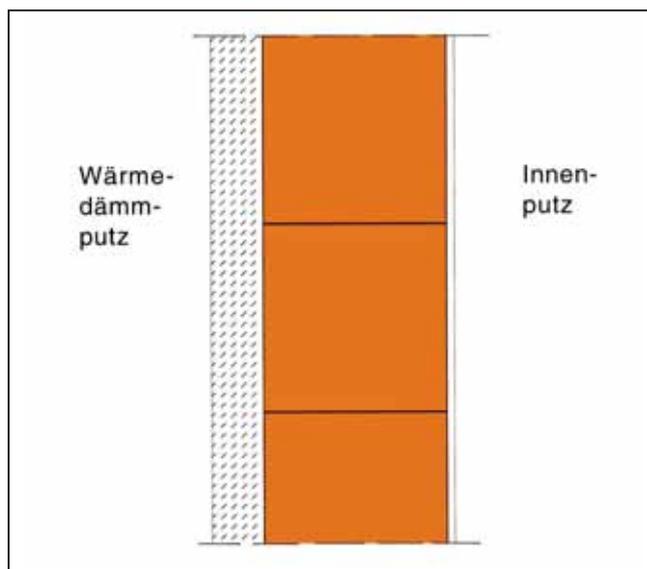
Schnitt durch einschaliges PlanZiegelmauerwerk und Dämmputz auf der Außenseite.
